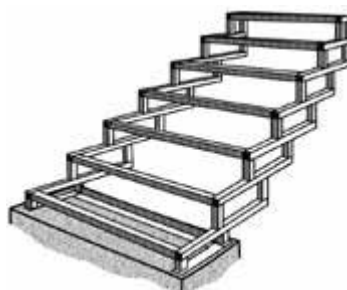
Конструкция каркаса лестничного марша из профилированной трубы
